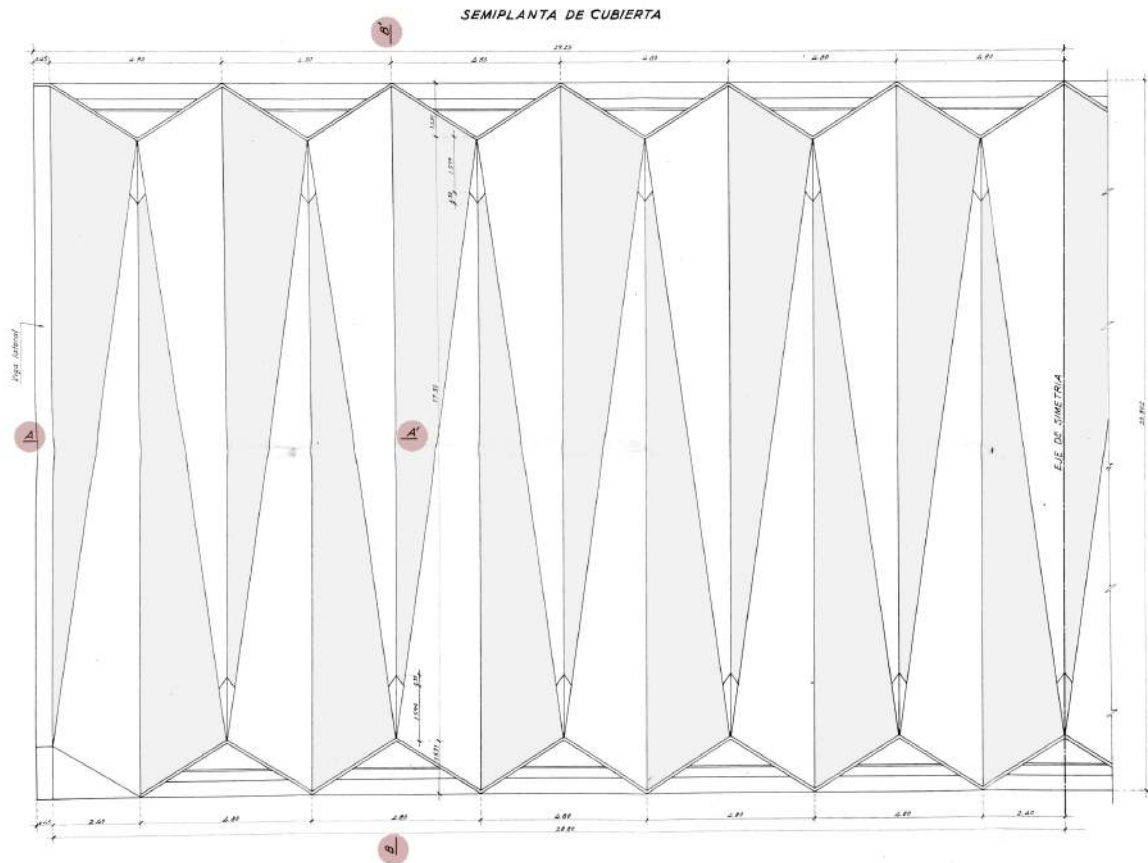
SEMIPLANTA DE CUBIERTA
